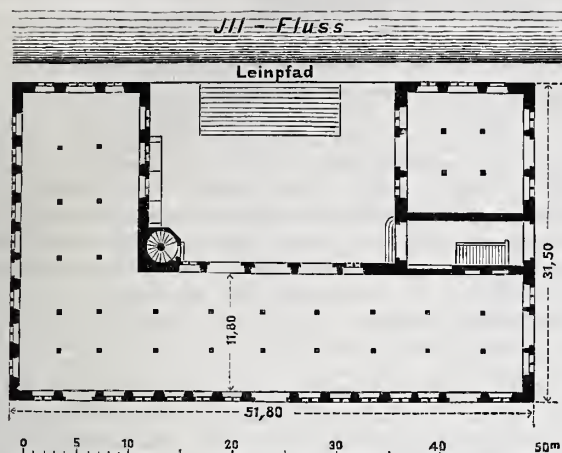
Grundriss der großen Metzger in Straßburg i. E.
